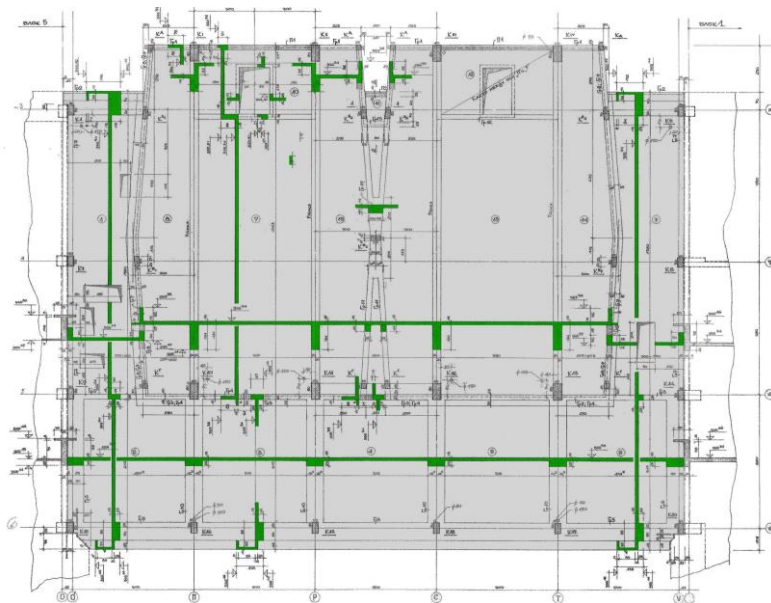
Котражен план на плоча – кота 557,74 и пода на залите на блок 4 на УАСГ
